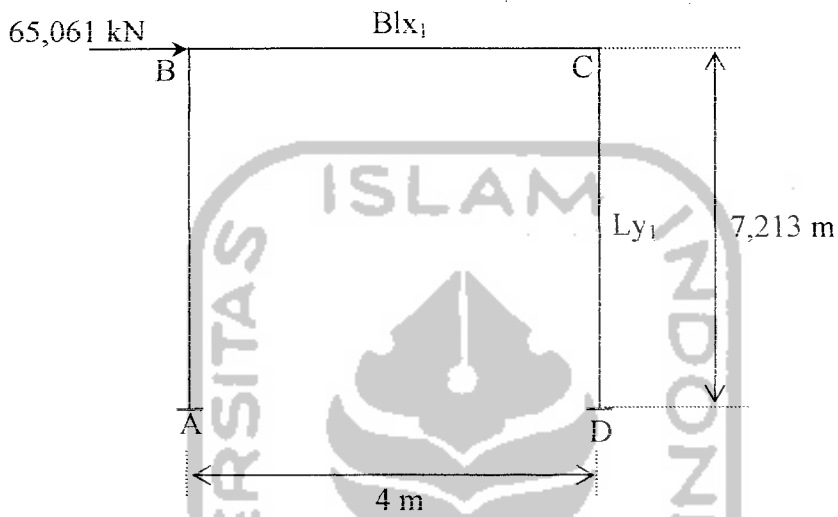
Penempatan gaya yang bekerja pada Portal Ujung Struktur Jembatan Rangka Baja
